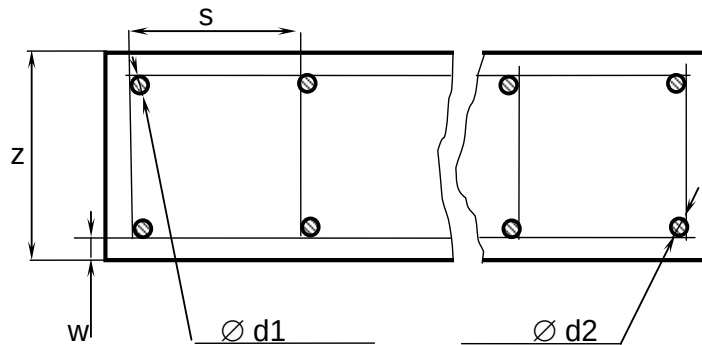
Схема розташування стержнів та діаметри арматури стіни
